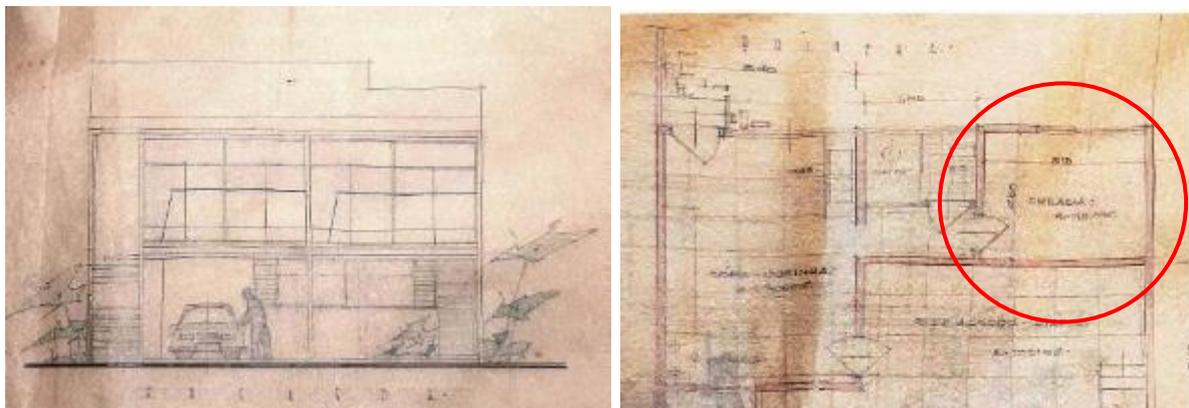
Casa Silvio Bentes – Fachada e detalhe da Planta Baixa com o termo “Creada” – pranchas originais digitalizadas. Fonte: Acervo LAHCA.
